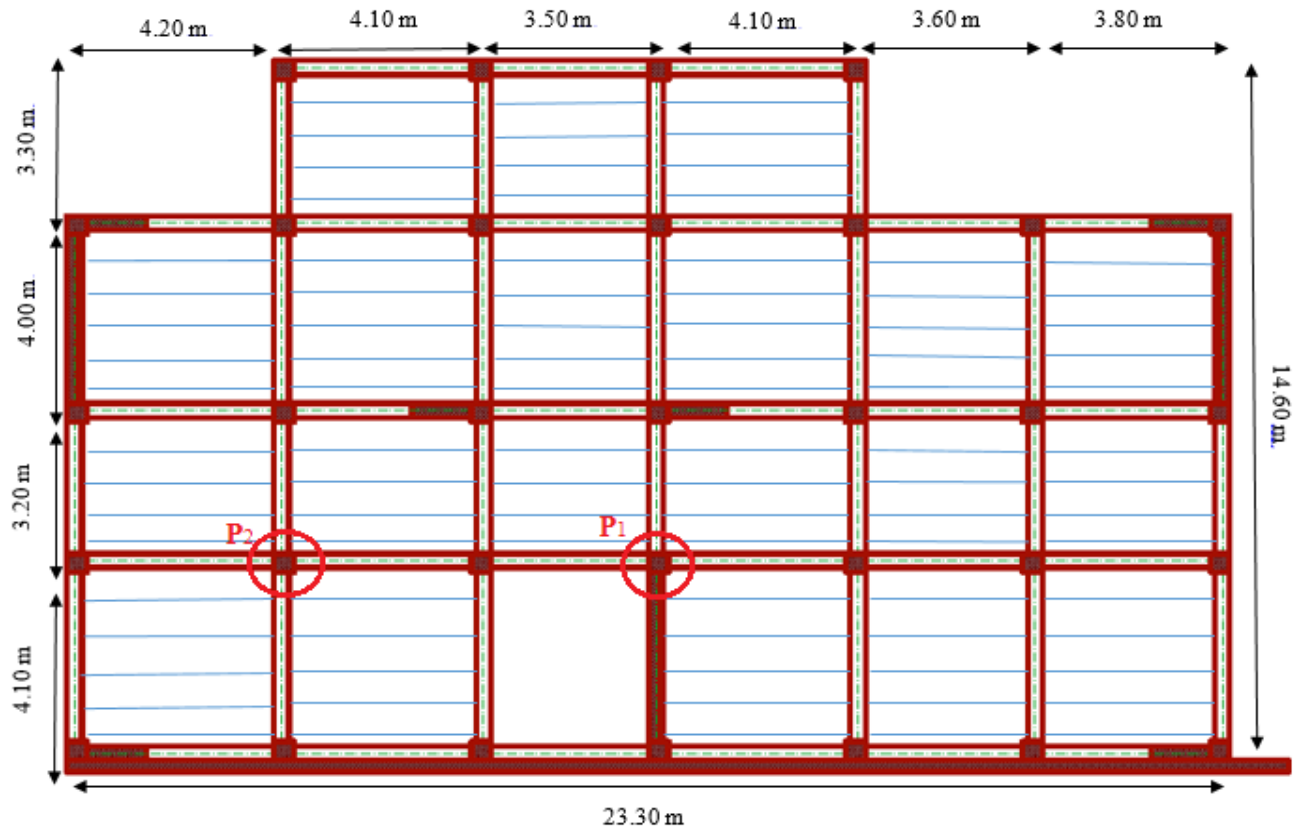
Vue en plan des poteaux les plus sollicités.
